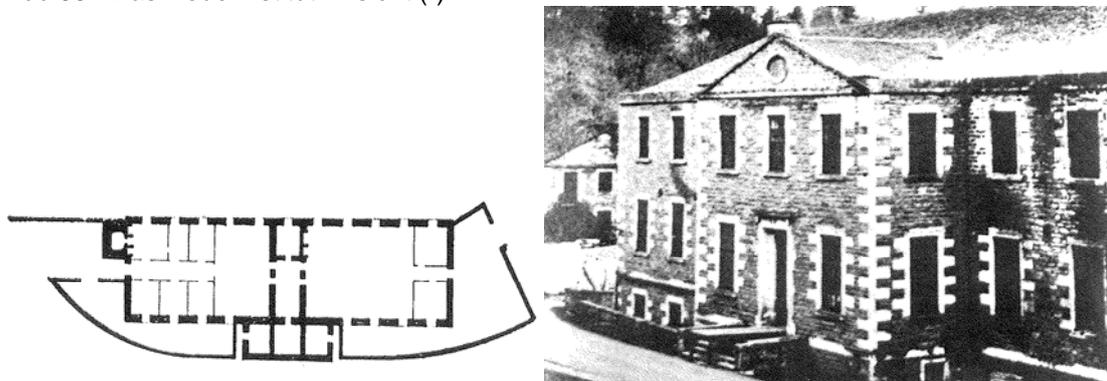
Das Schulgebäude in New Lanark, Grundriss (l)
